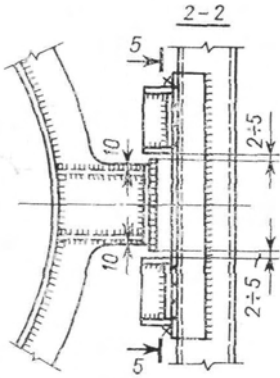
Схема и детали скользящих опор газотводящего ствола
